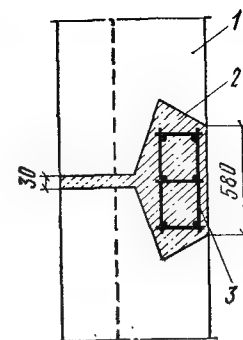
Узел сопряжения стеновых панелей (в плане)
